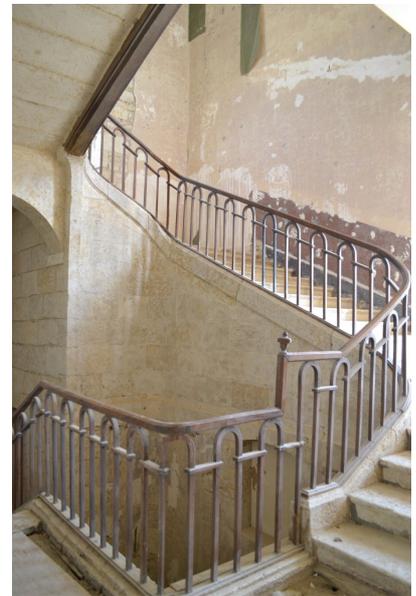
Logis, rez-de-chaussée, escalier d'honneur (travaux en cours).
